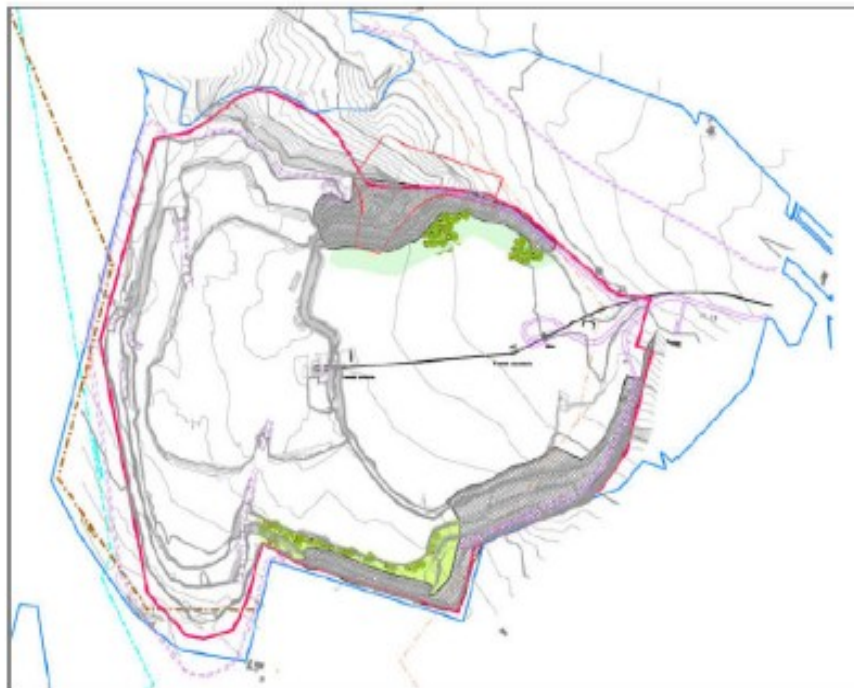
Estratto della planimetria attuale (fine 2025) con lo stato di avanzamento del recupero aggiornato.
